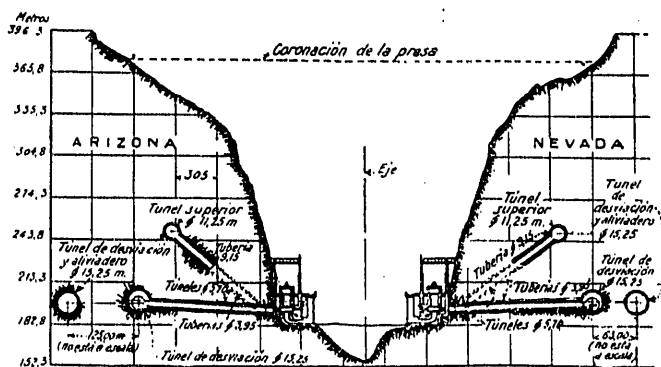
Sección transversal del Cañón del Colorado por el sitio de la casa de máquinas, indicando la disposición de los túneles y tuberías
